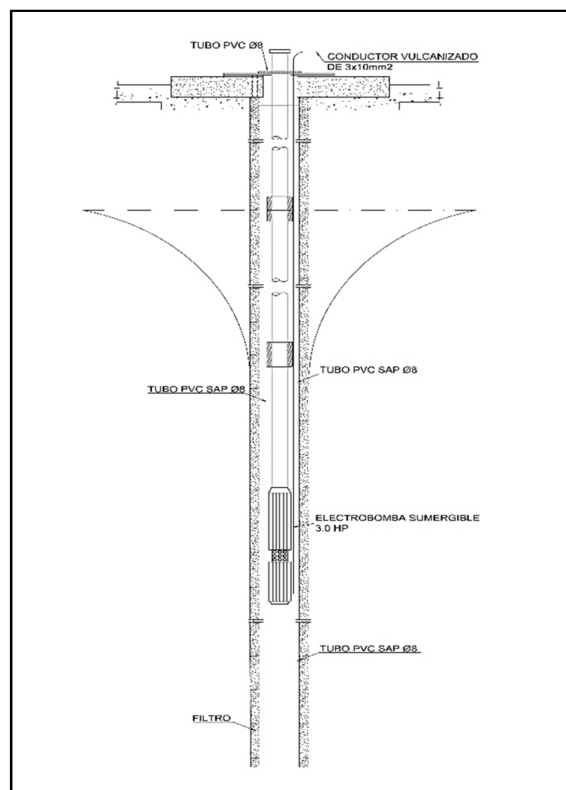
SECCIÓN DE POZO TUBULAR.
